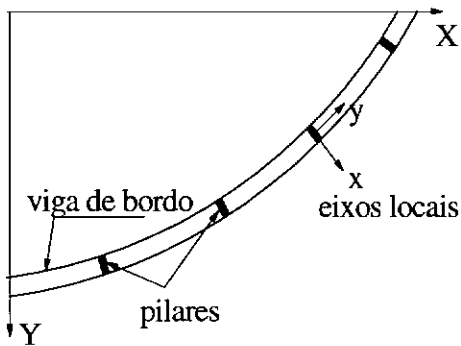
a Posição em planta dos pilares (1/4 da malha)
